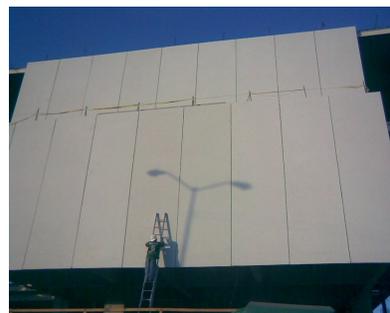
Extraída con fines didácticos, Montaje de Elementos Prefabricados, Fapresa. Obra: Parador Azteca
